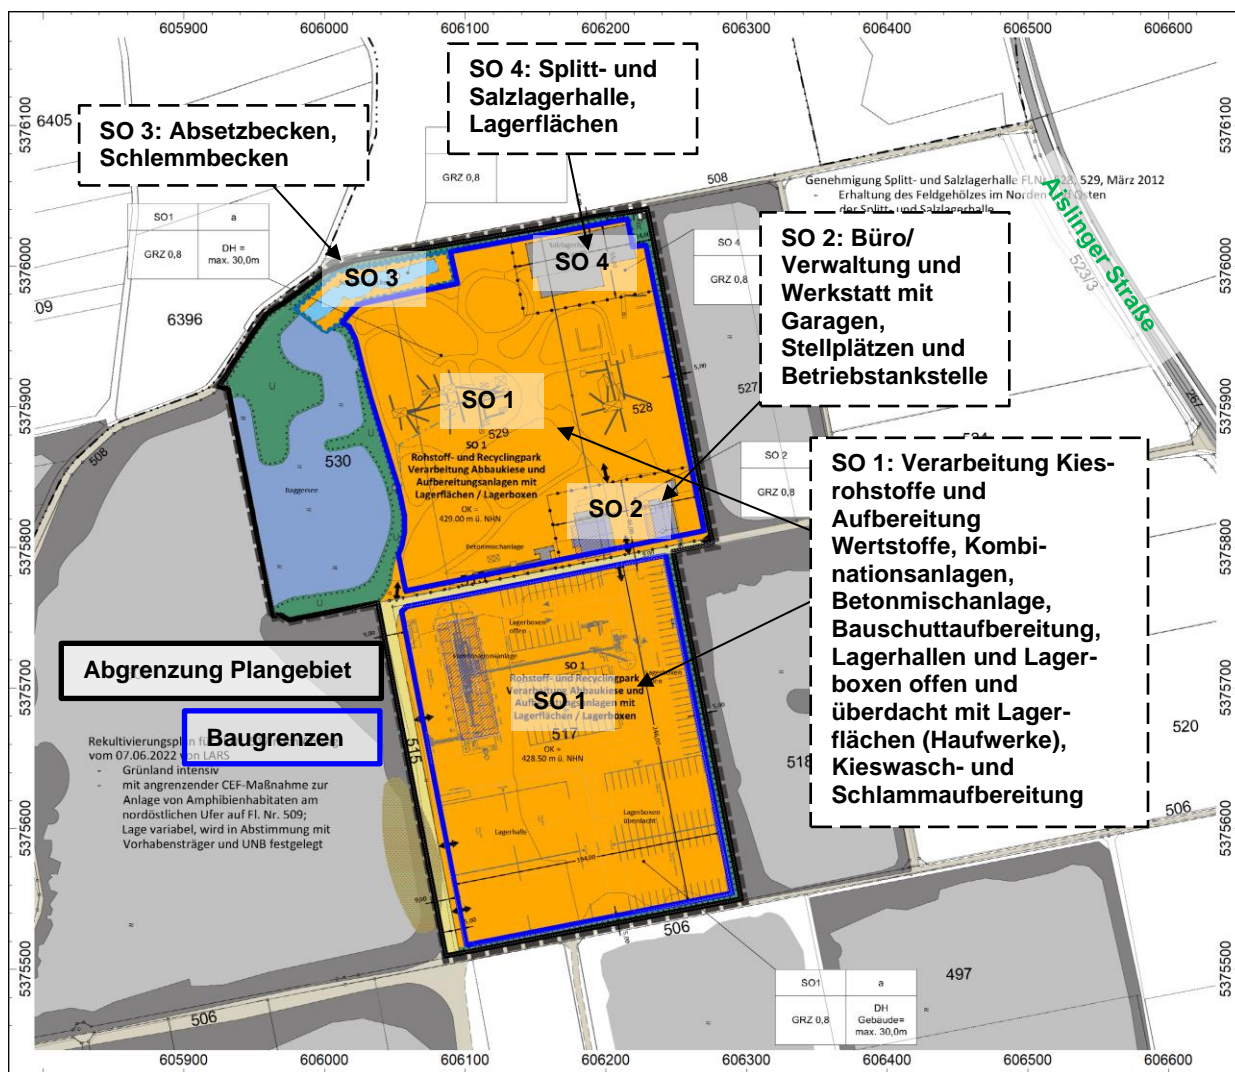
Lageplan mit Abgrenzung des Plangebiets „Rohstoff- und Recyclingpark Aislingen“ /15/
